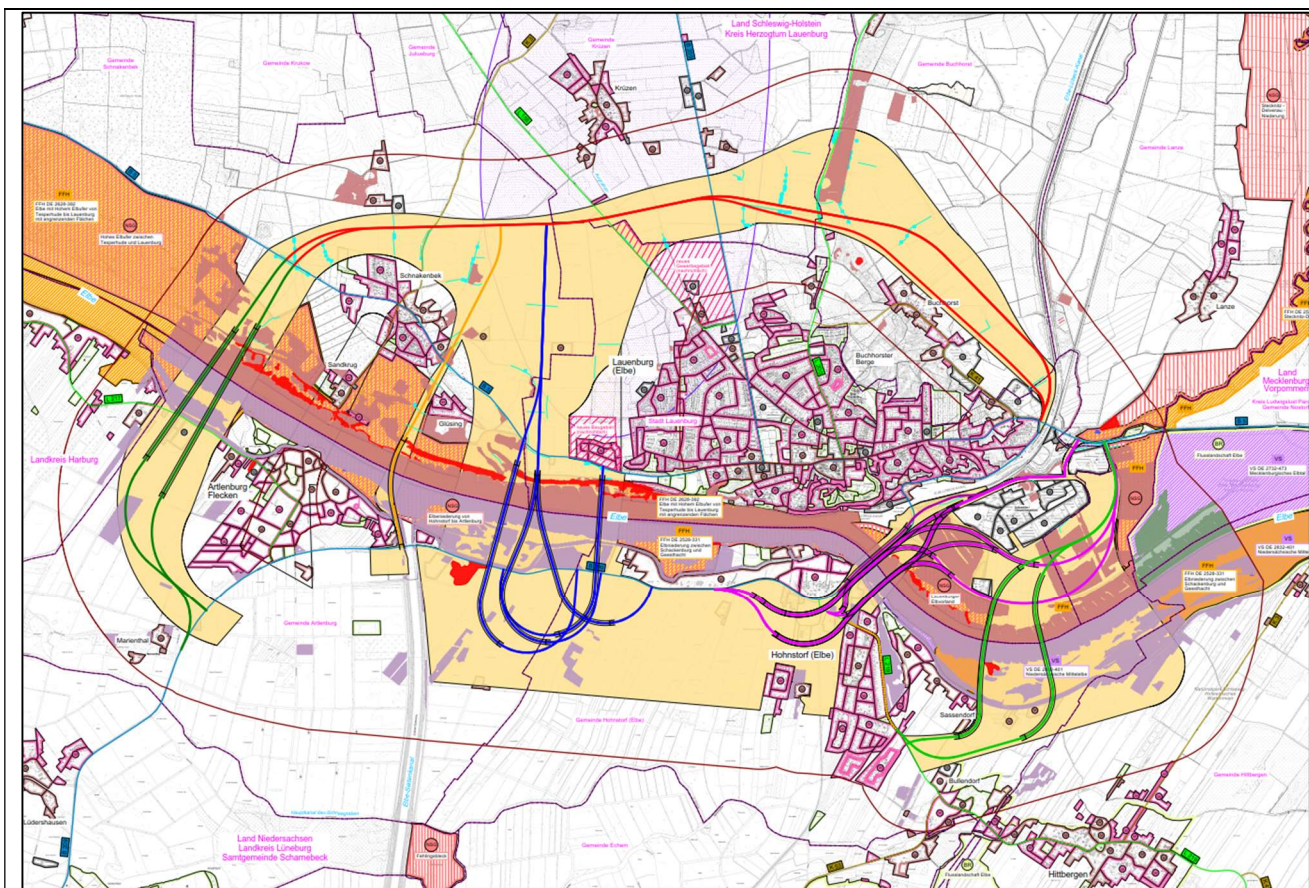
Übersichtslageplan Brückenvarianten (Vorabzug, Stand Juni 2023, Änderungen vorbehalten)
